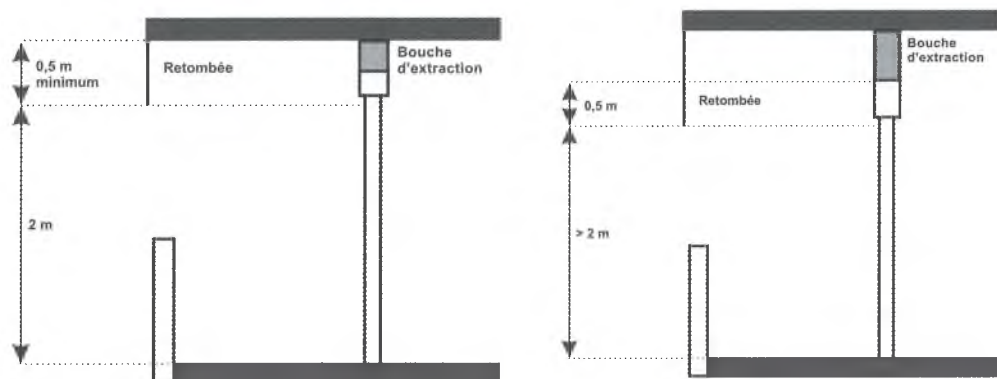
Retombées sous plafond (écrans de cantonnement).
